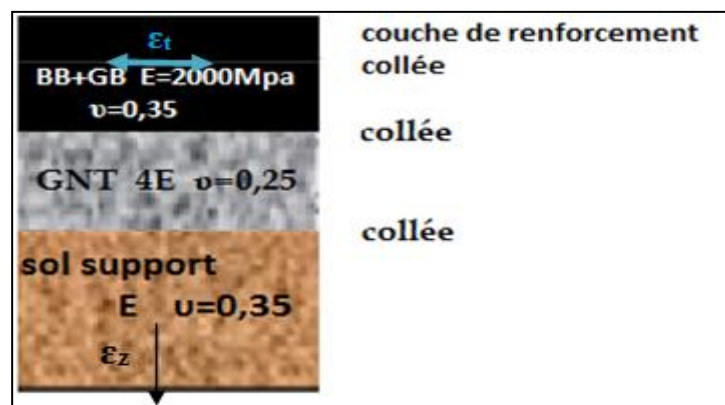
Structure type de chaussée à renforcer par ALLIZEIII
